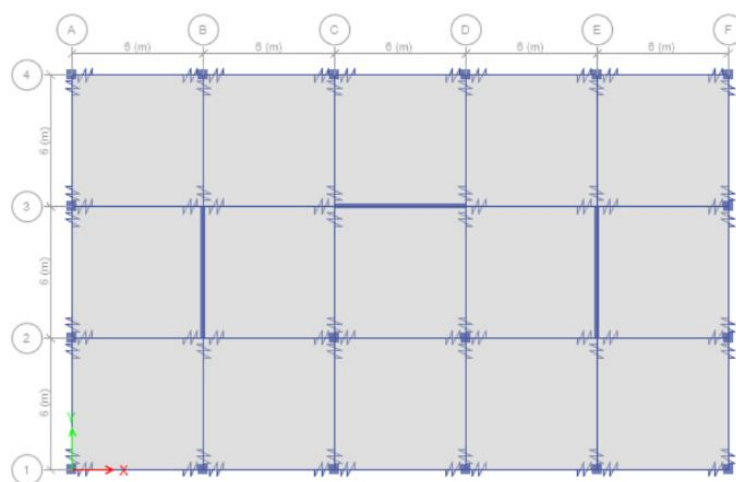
Distribución de rótulas perfectas en planta estructura auxiliar Edificio Tipo 2
